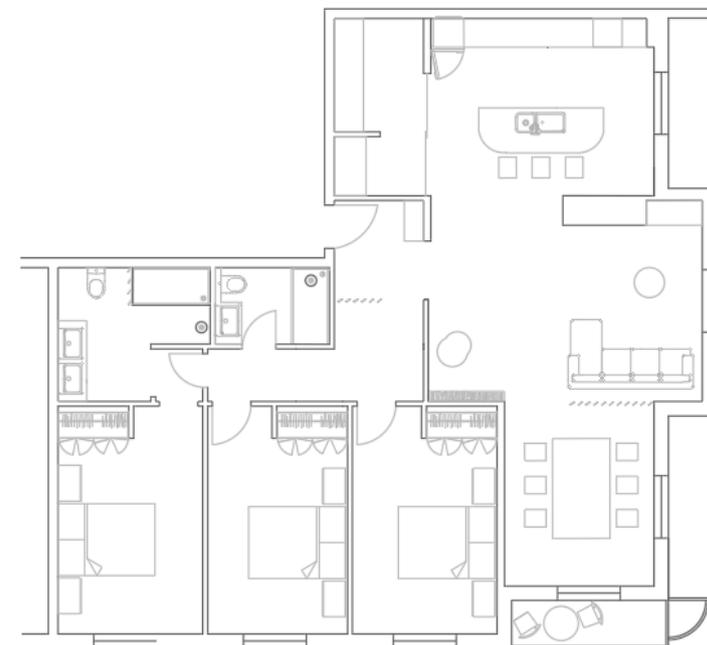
Esboço, planta 2d, André Bastos; 14\01\2023
